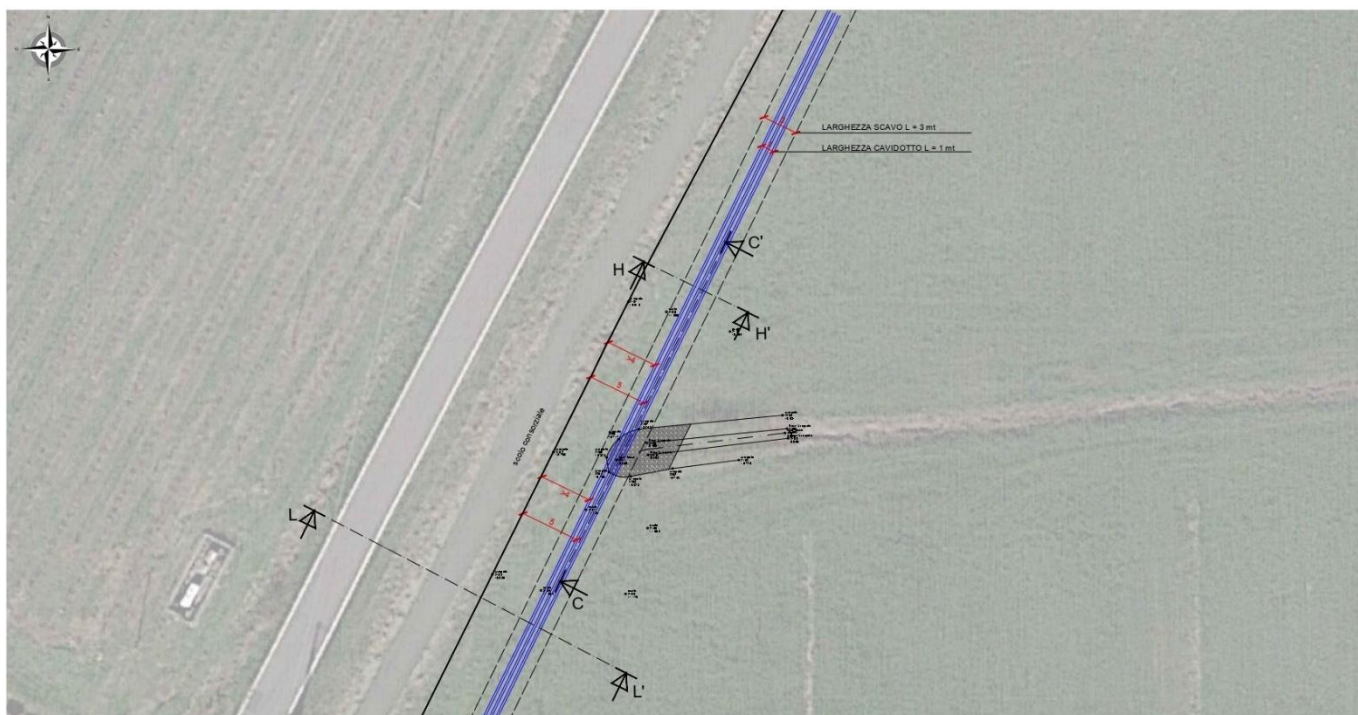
Tratto C-C'- Rilievo planoaltimetrico post-intervento
